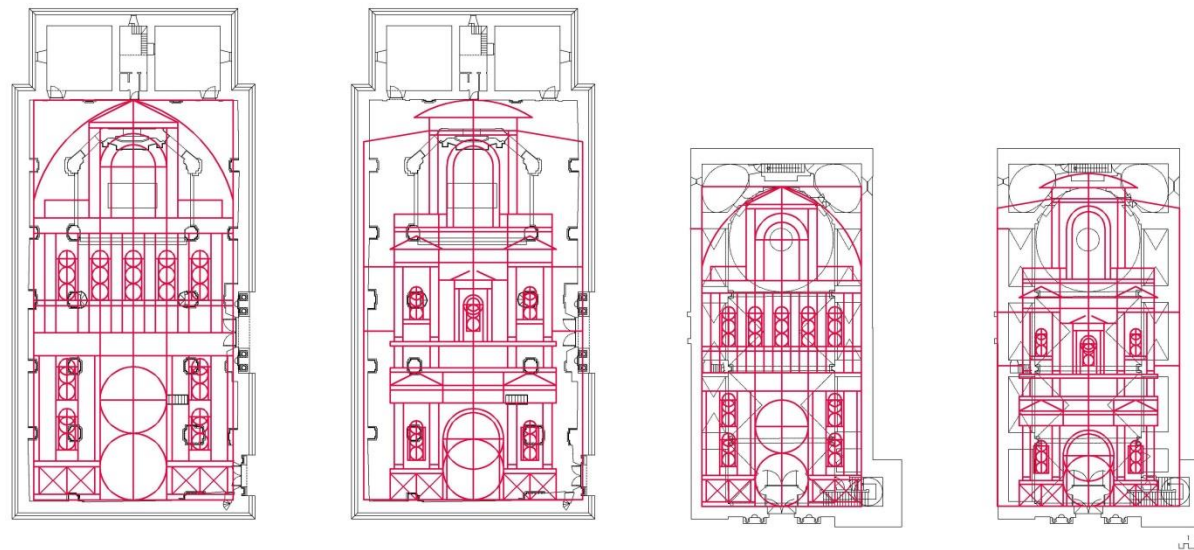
Esquemas de fachadas retablo sobre planta iglesia de Vistabella (Castellón) y Andorra (Teruel).
